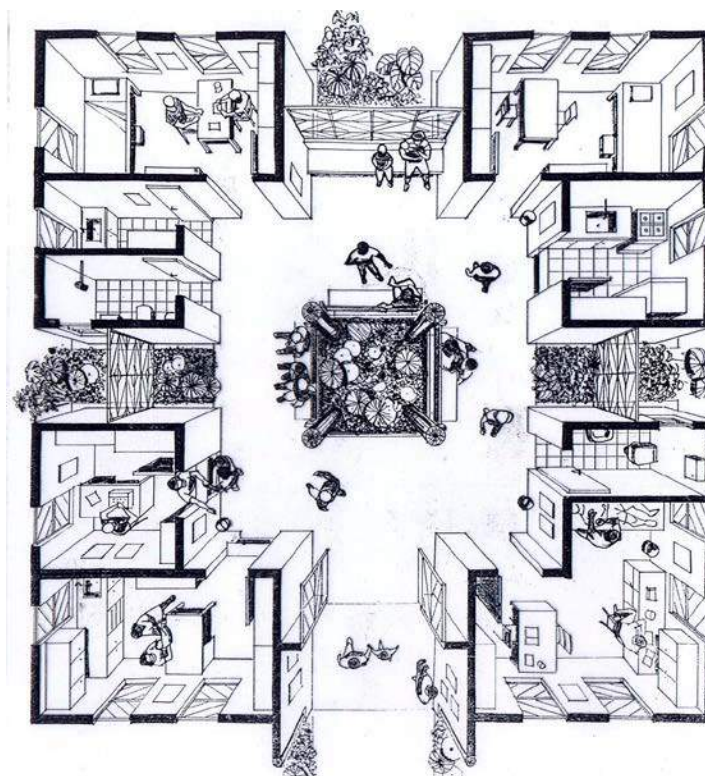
Planta Baixa Perspectivada da Unidade de Saúde
